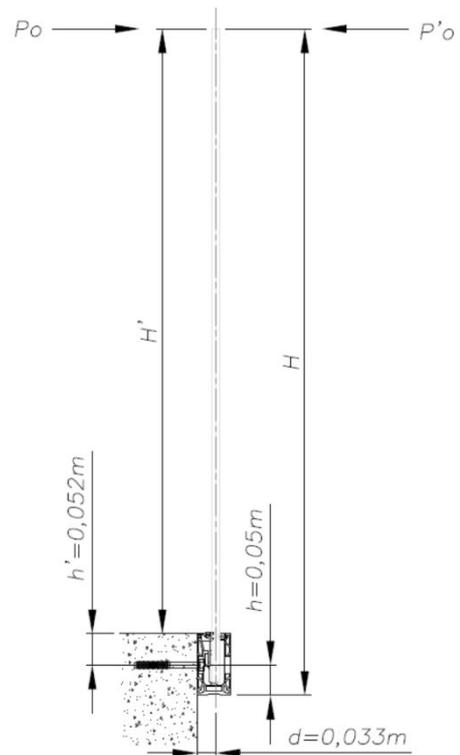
Dimensionnement des chevilles de fixation montage latéral
